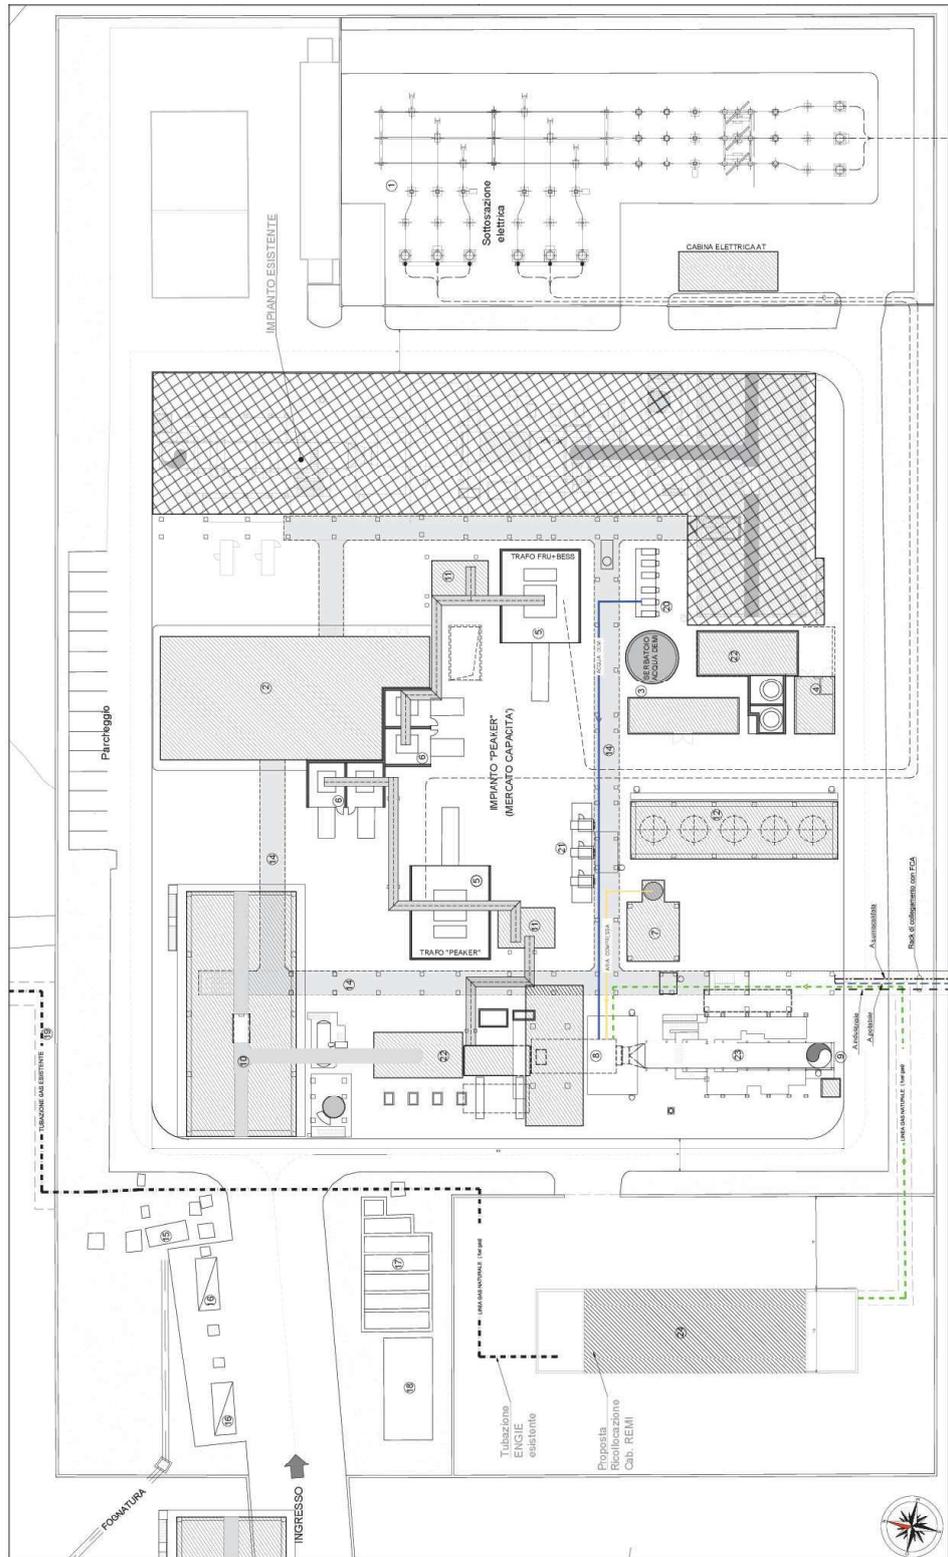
PLANIMETRIA GENERALE DI PROGETTO
